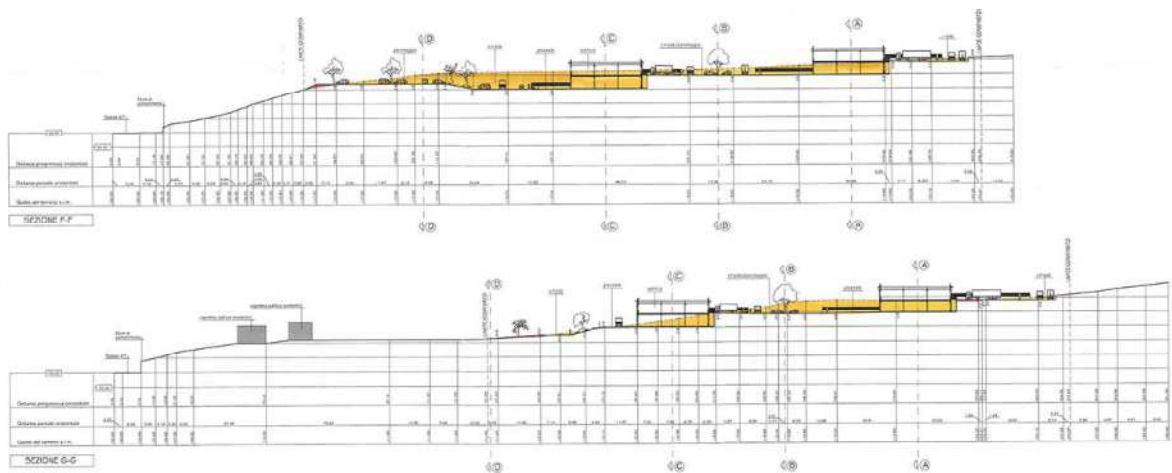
Estratto Tav. n. 9 – sezioni PUC vigente
